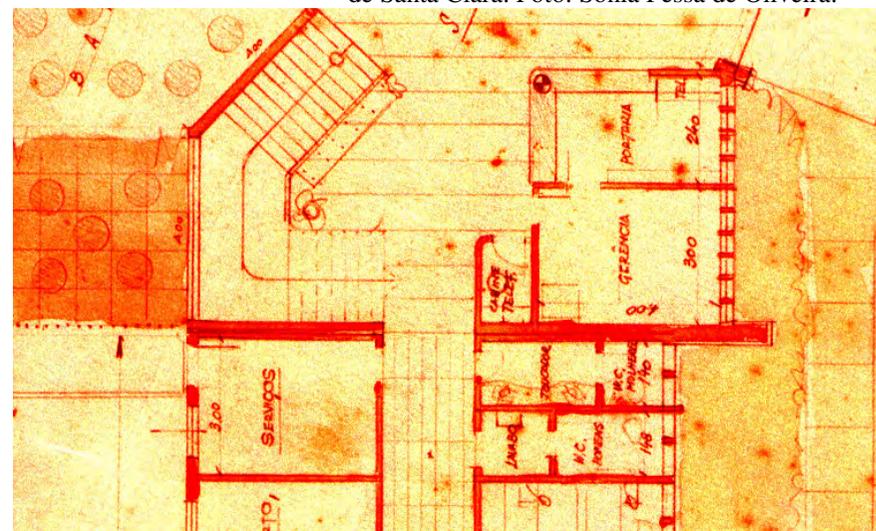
Planta baixa da sala de gerência e portaria do Hotel Águas de Santa Clara. Fonte: Projeto original cedido pelo Engenheiro. Romeu P. da Costa.
